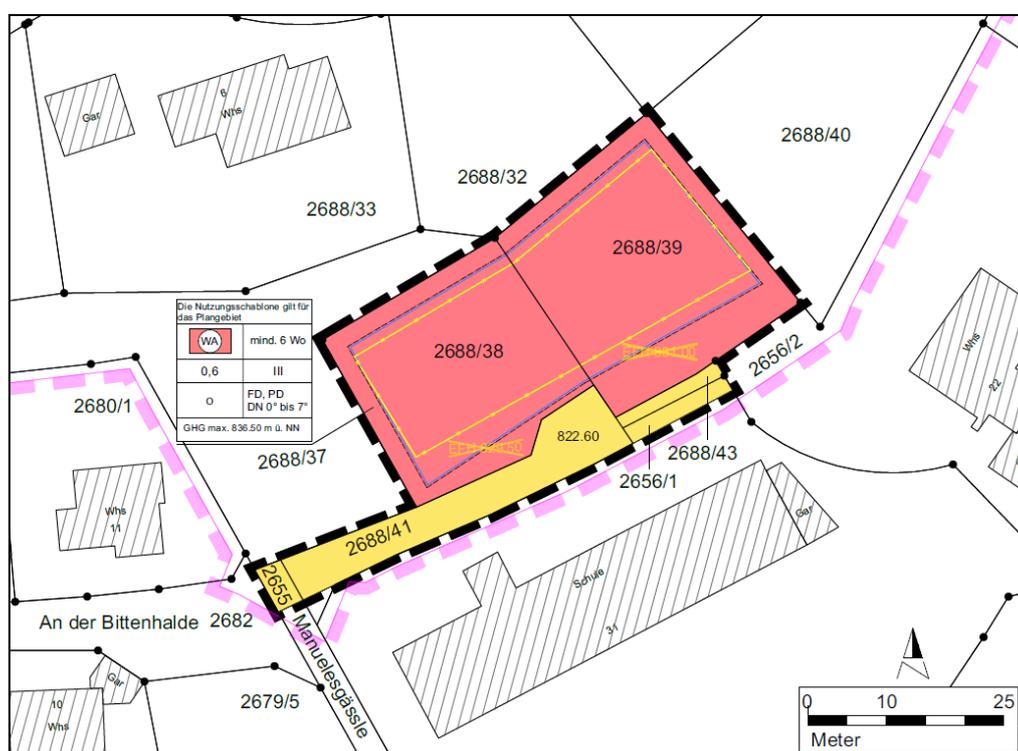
Bebauungsplan „Haldenstraße, 2. Änderung“ (Entwurf vom 05.01.2023)
